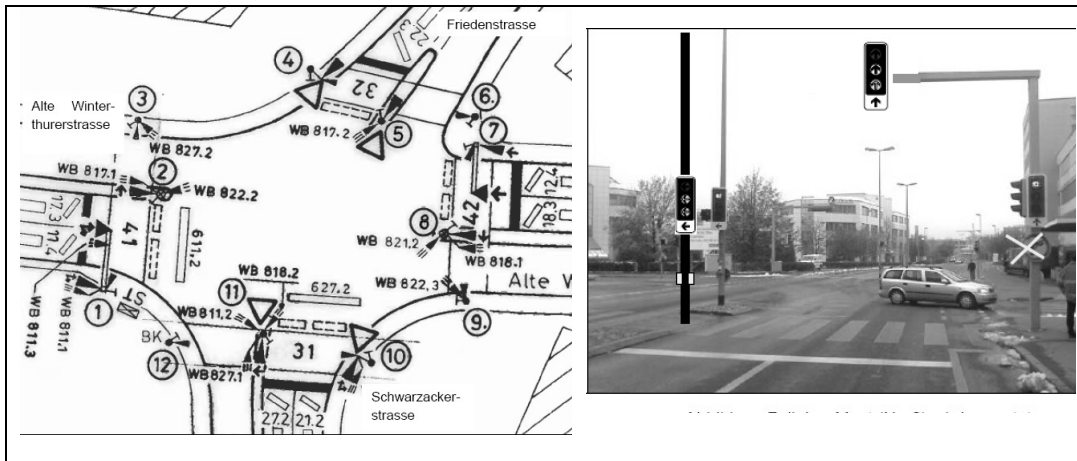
Signallageplan und Teilansicht LSA Wallisellen
